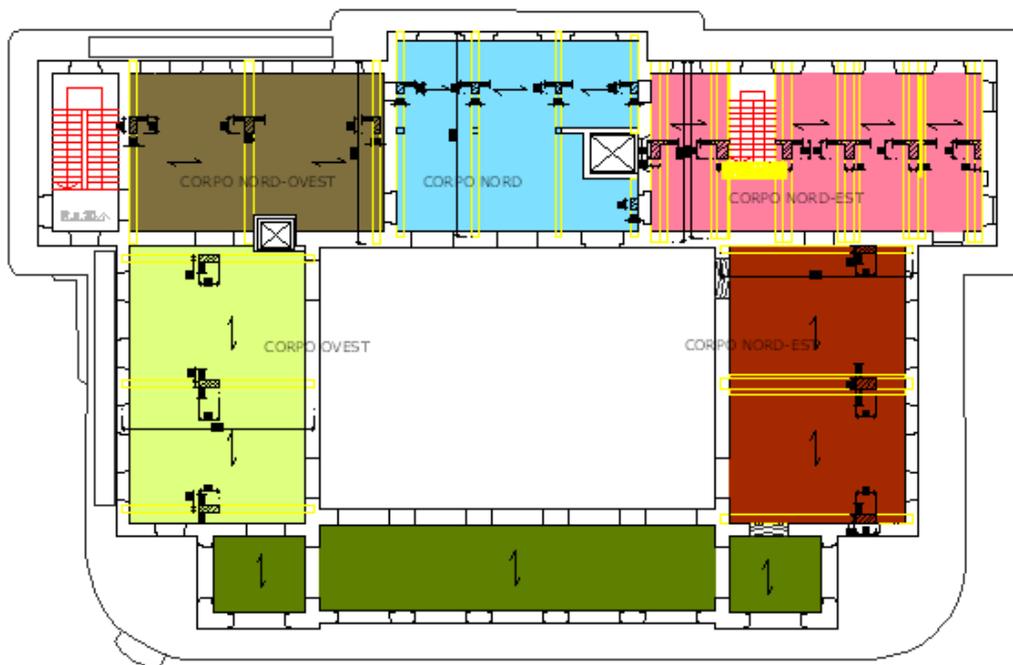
Pianta dei muri del piano terra con individuazione dei solai di piano primo
